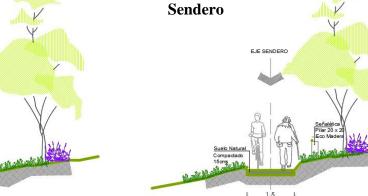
Perfil Existente y Propuesto Quebrada Las Higueras.
